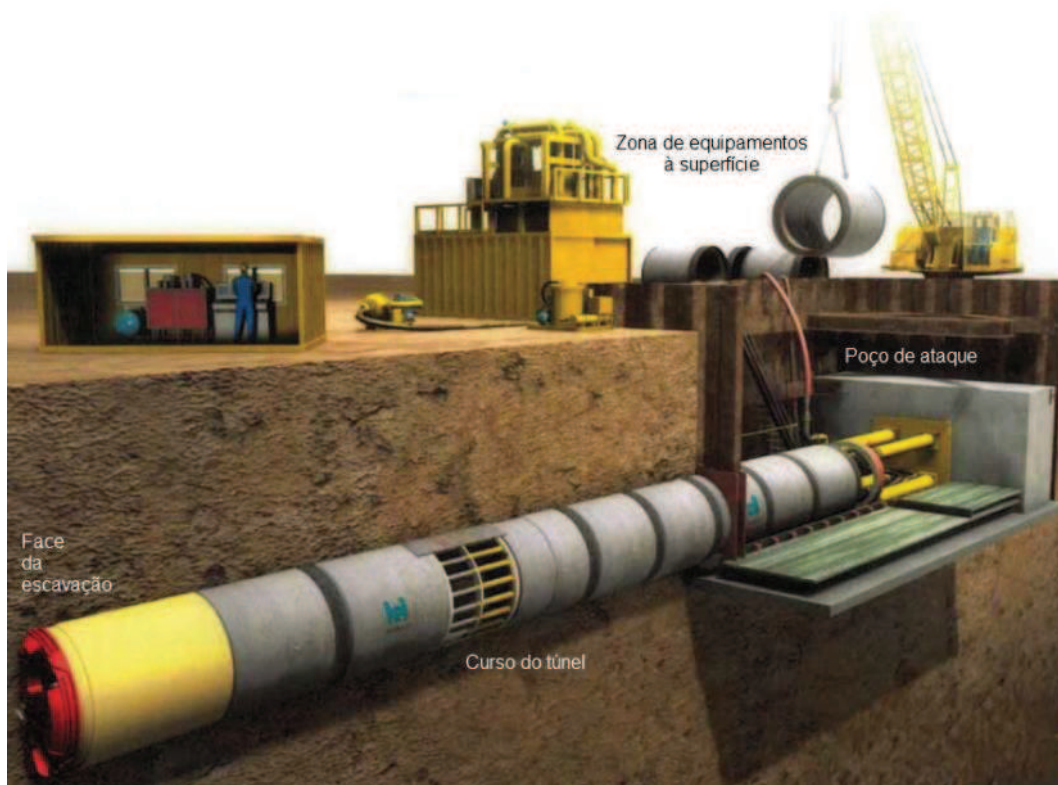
Zonas de *pipe jacking*, adaptado de (HOBAS 2010)
